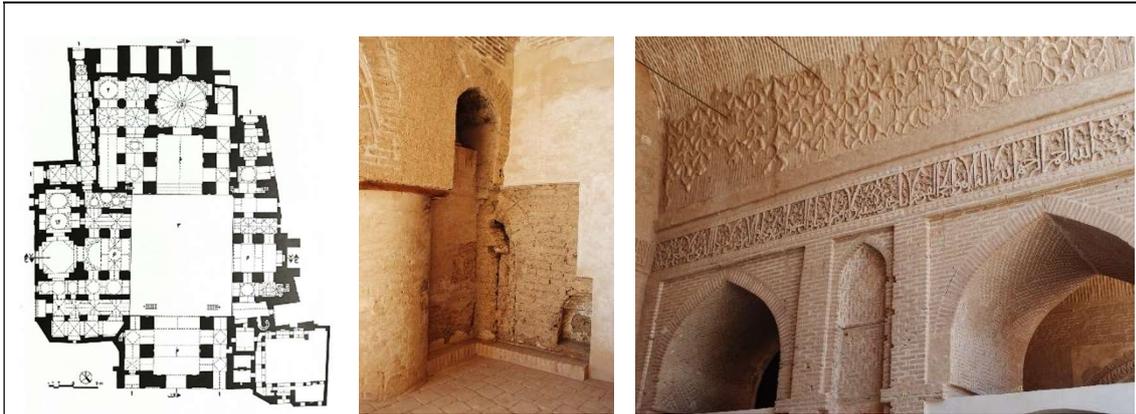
Freitagmoschee, Ardestan, Grundriss [3]
